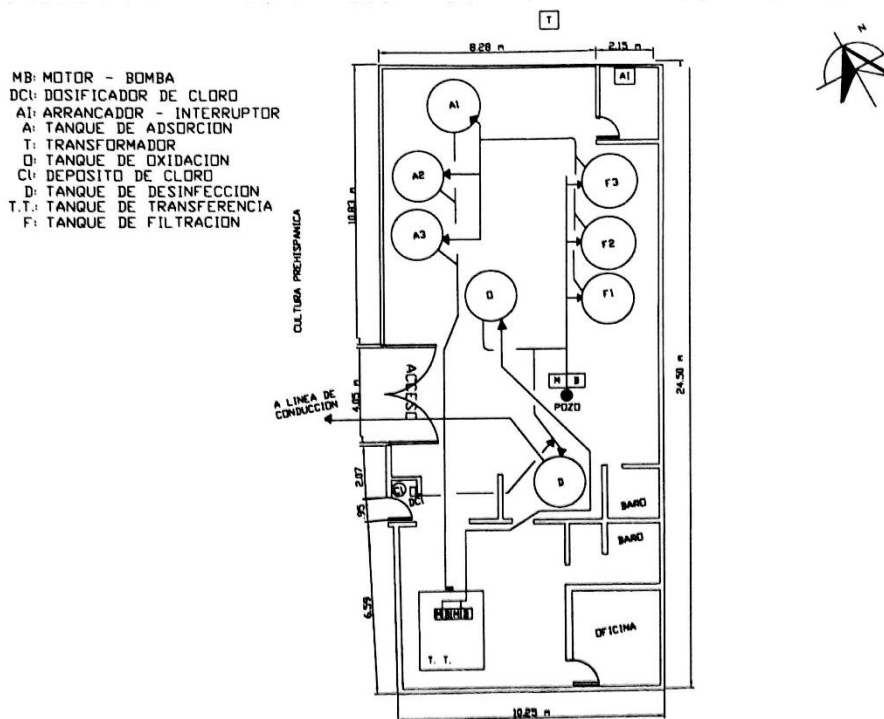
Vista en planta de la PP Granjas San Antonio
